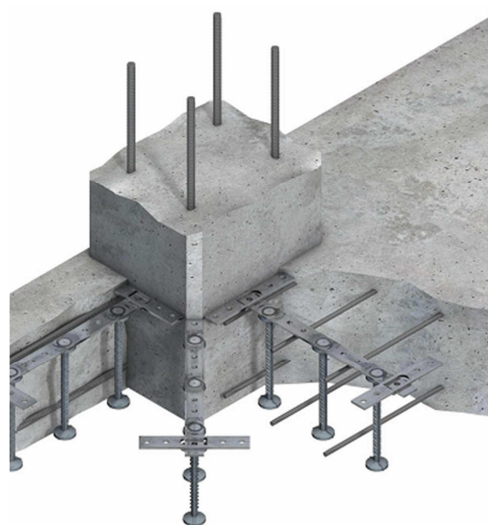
Tipos de armaduras de cisalhamento para lajes lisas (Ferreira, 2010)
